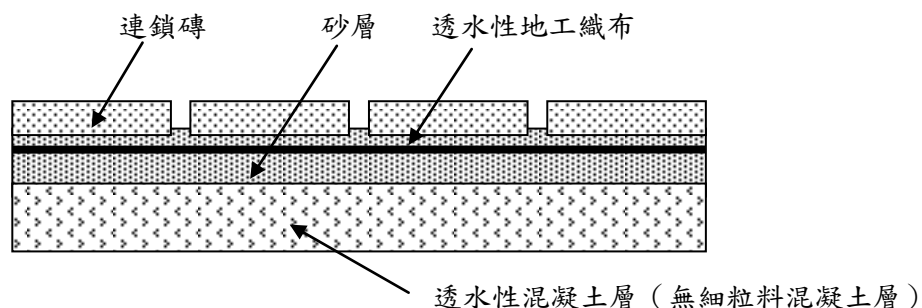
透水性混凝土（無細粒料混凝土）作為連鎖磚鋪面底層之示意圖
